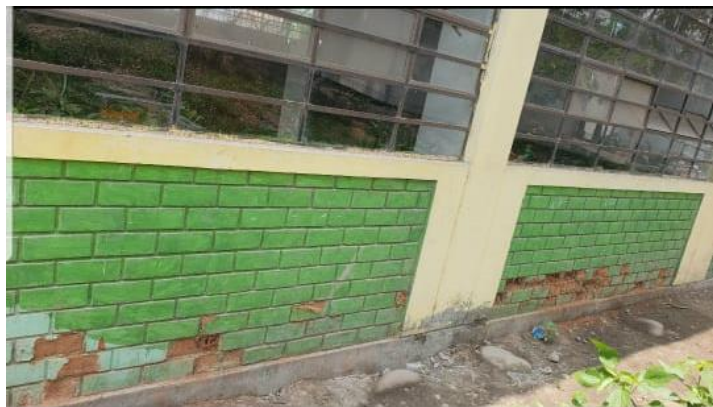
Paredes deterioradas. Fuente: Fotografía propia.
